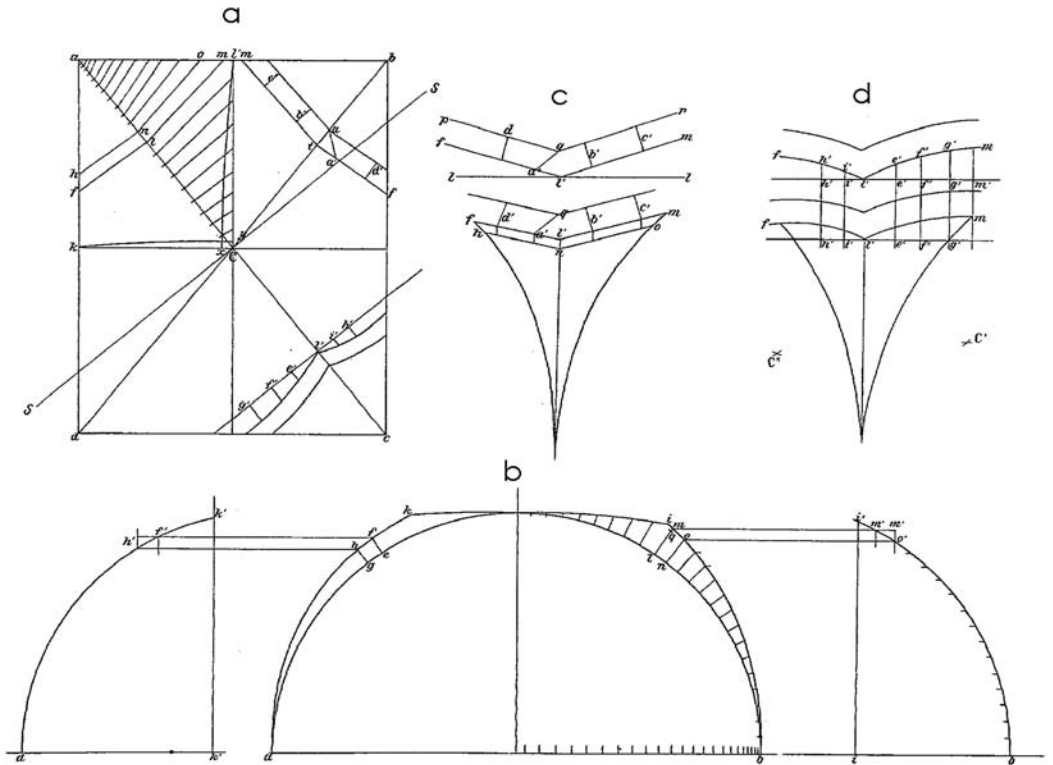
Disposición de la plementería con hiladas en continuidad sobre el nervio diagonal (Ungewitter 1875)
